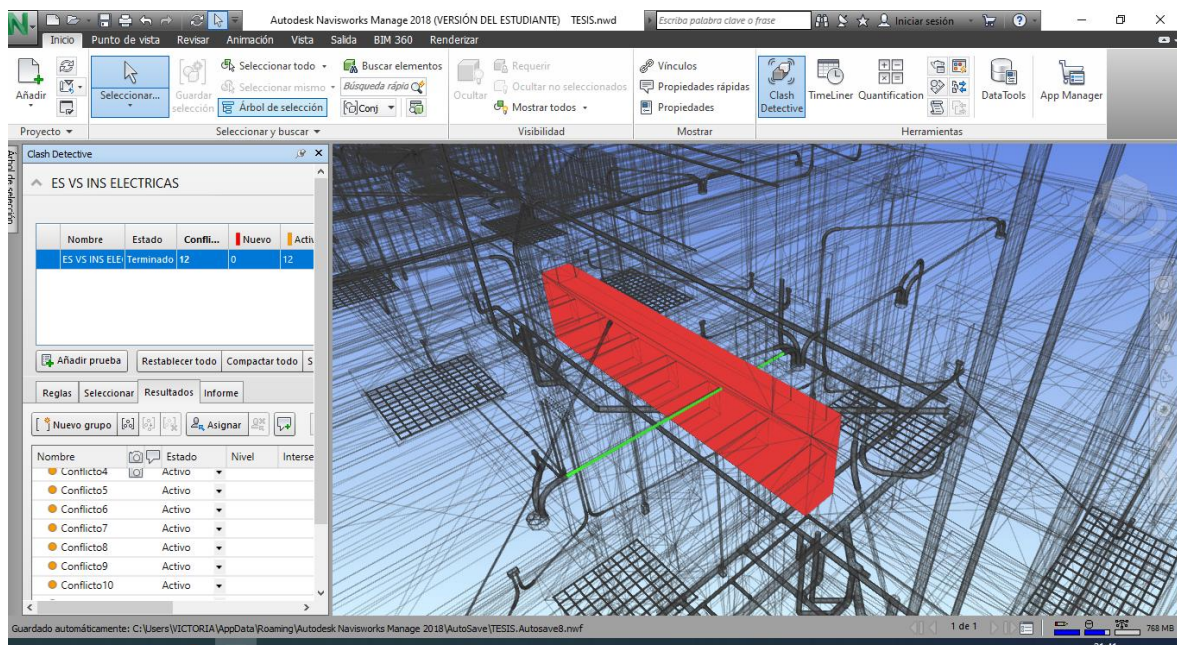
Interferencia entre viga y tubería de Instalaciones Eléctricas
